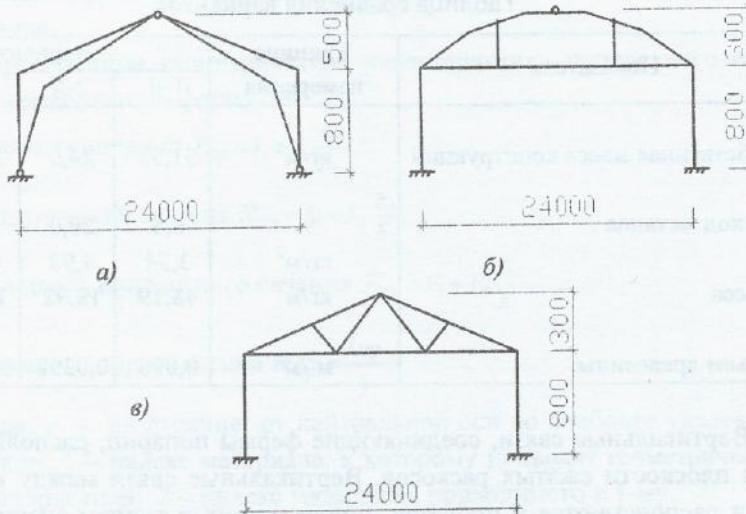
Варианты несущих конструкций: а – клееная рама из прямолинейных элементов; б – трехшарнирная арка кругового очертания; в – металлодеревянная ферма
